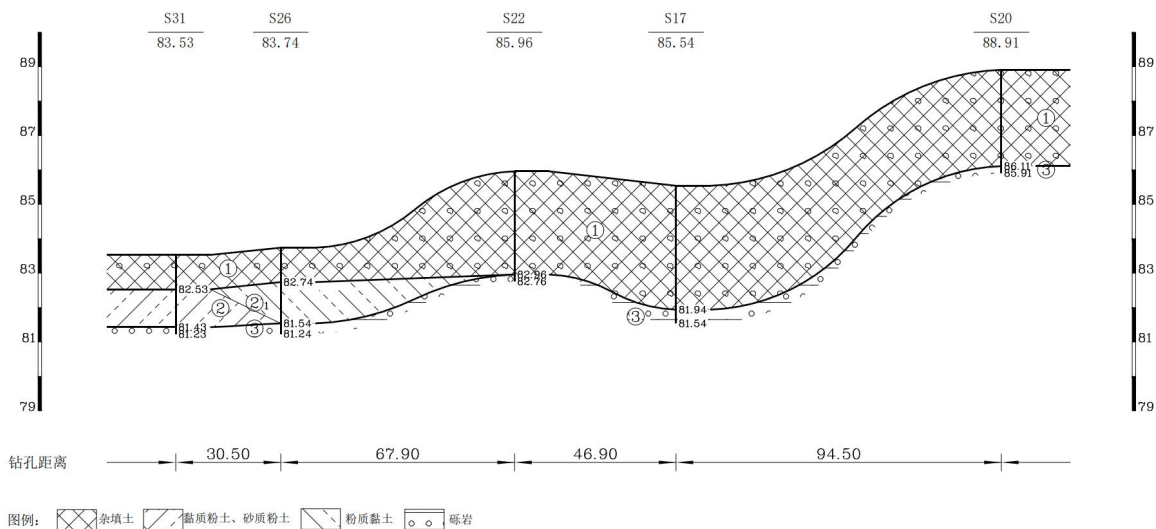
(剖面 3) 地块典型水文地质剖面图
